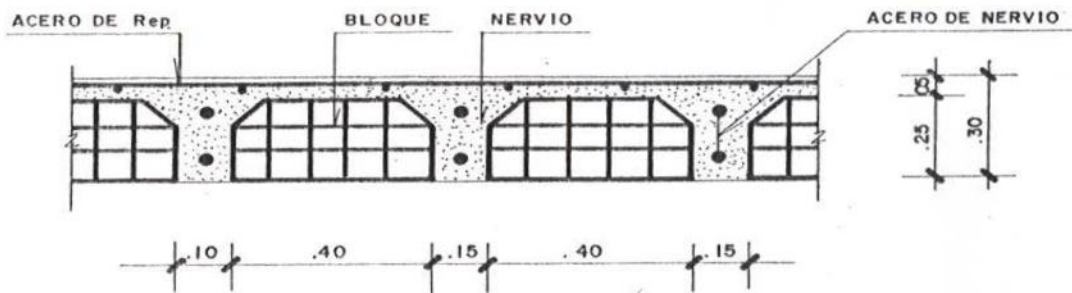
Detalle típico de losa nervada. Modulo de Barrio.
